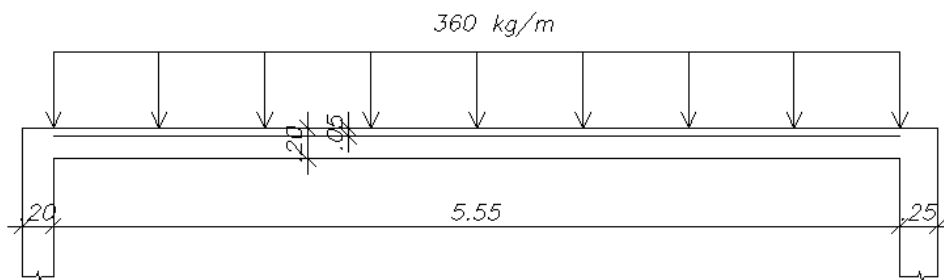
Losa aligerada convencional armada en una dirección
